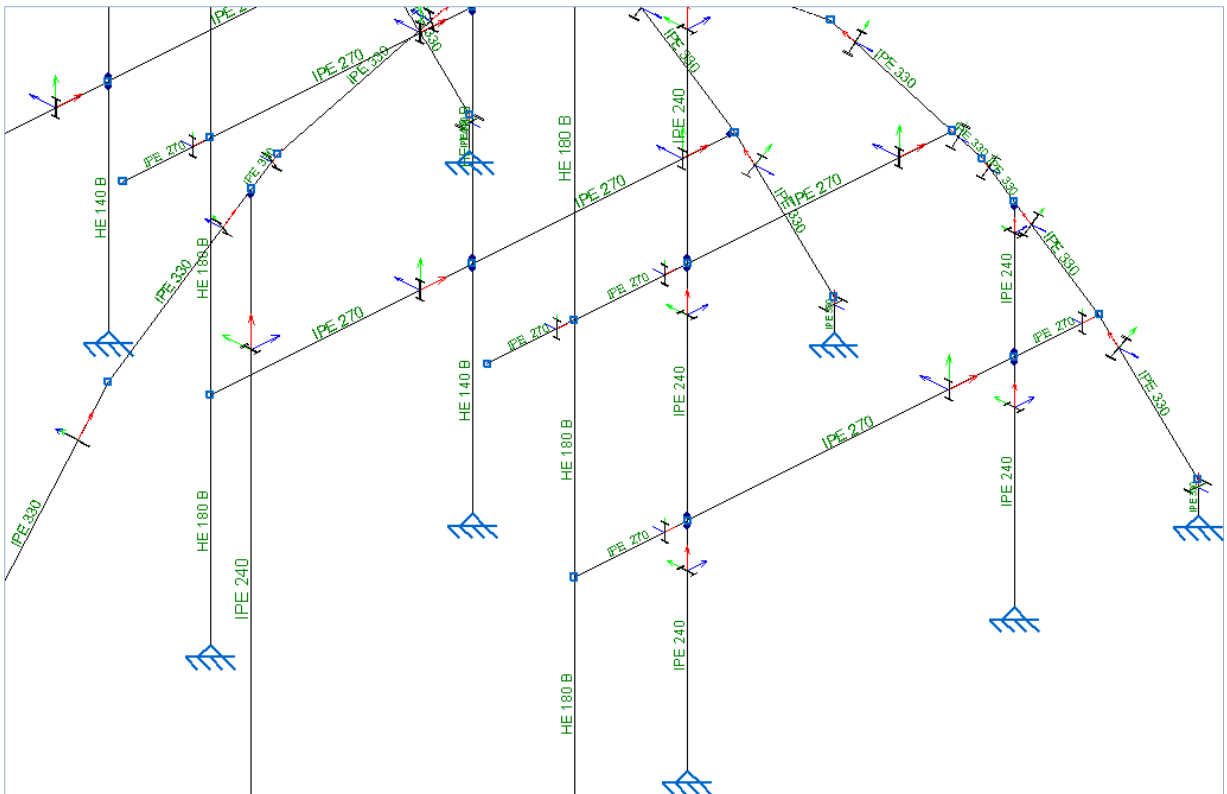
Representación en detalle de los pilares hastiales girados 90°
